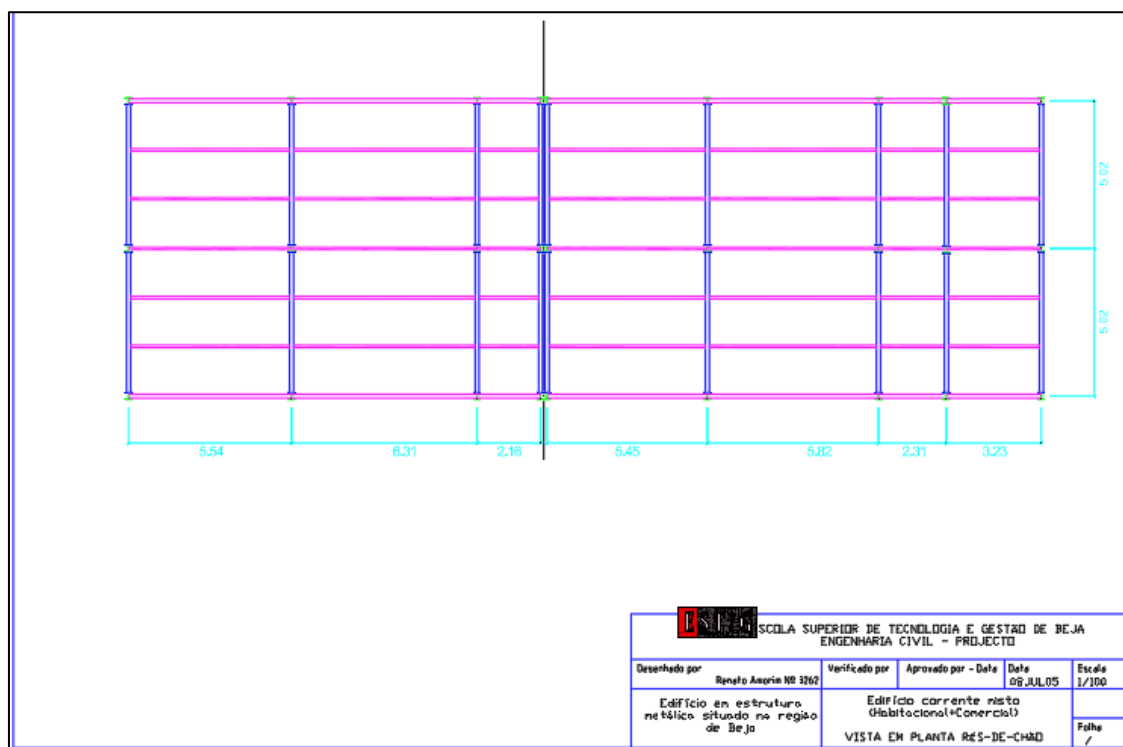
Planta do piso 0 - Desenho do AutoCad, segundo Amorim [8]
